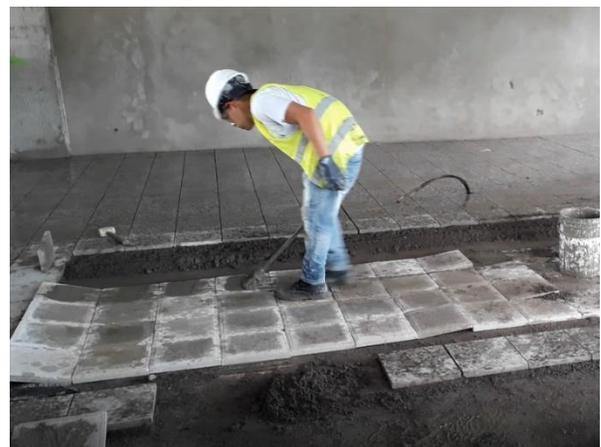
Detalle de "pinta" de piezas con pasta de cemento
